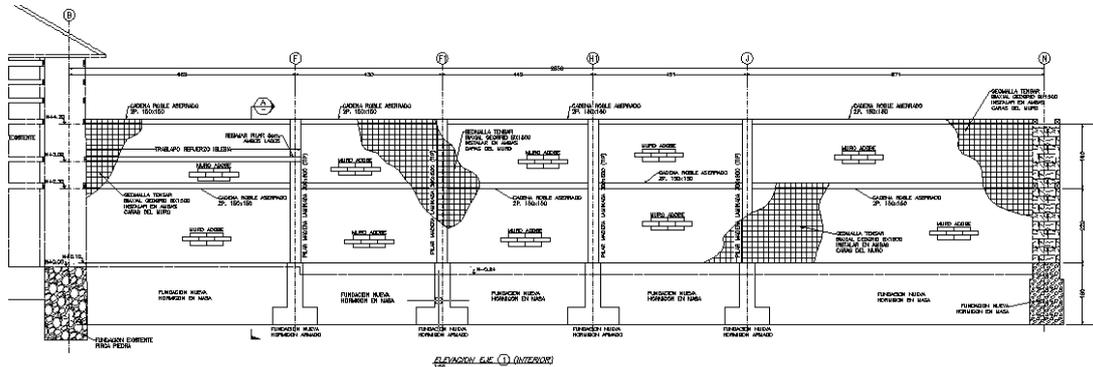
Propuesta de Albañilería Confinada en Casa Parroquial, Gualleco[4]
